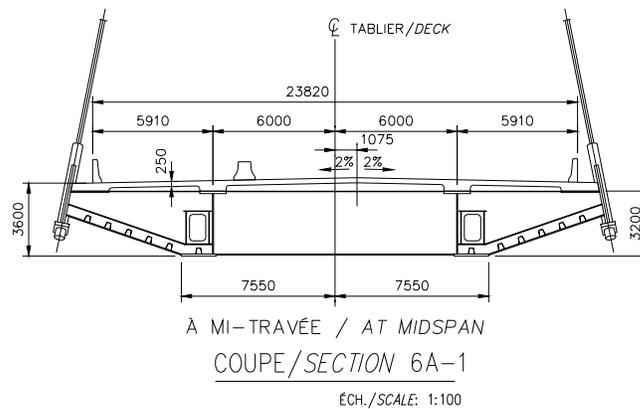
Coupe transversale – Pont à haubans – Solution bicaissons
